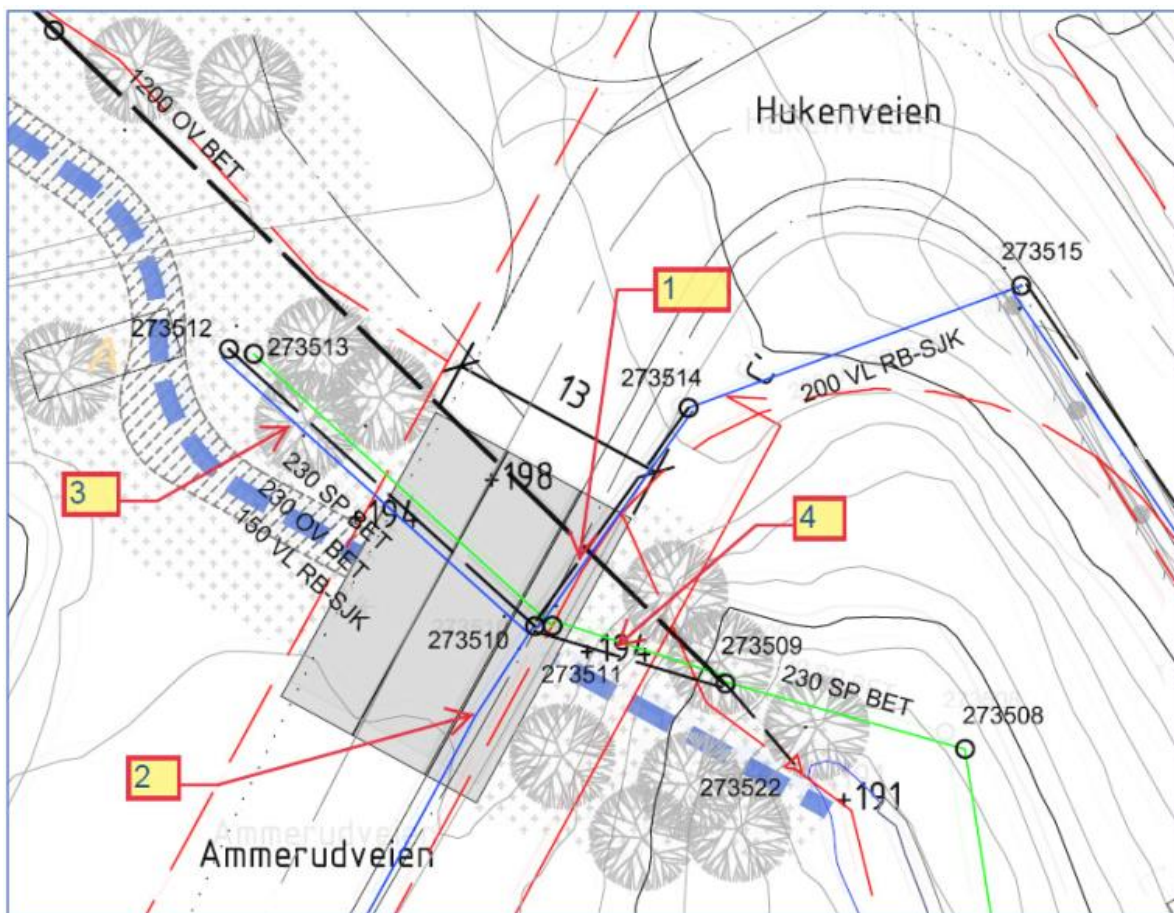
Mulig ny plassering av trafo på østsiden av bekkeåpningen.
